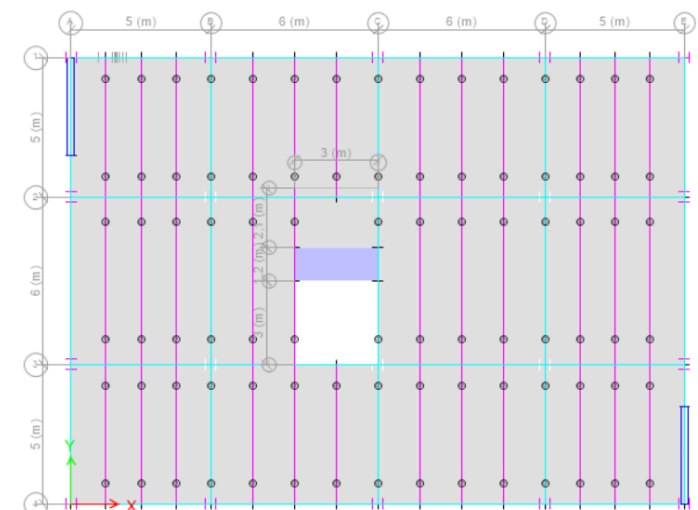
Vista en planta ubicación de los muros en estructura de acero.
